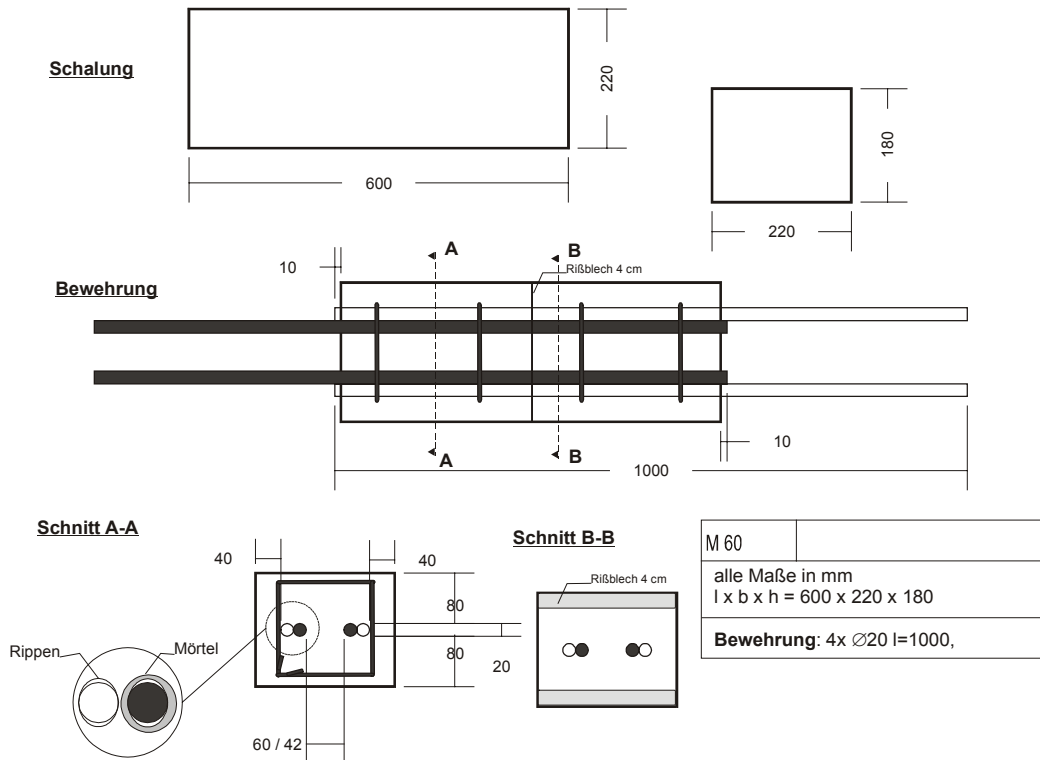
Schal- und Bewehrungsplan für Dehnkörper mit Querbewehrung
